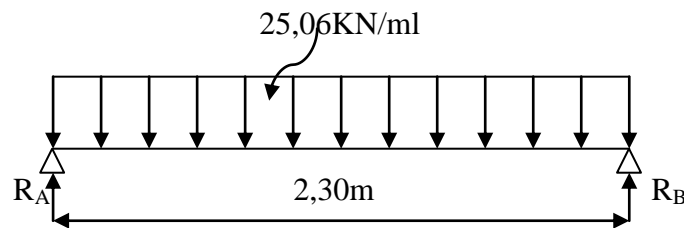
Schéma statique de la poutre palière à l' ELS.
